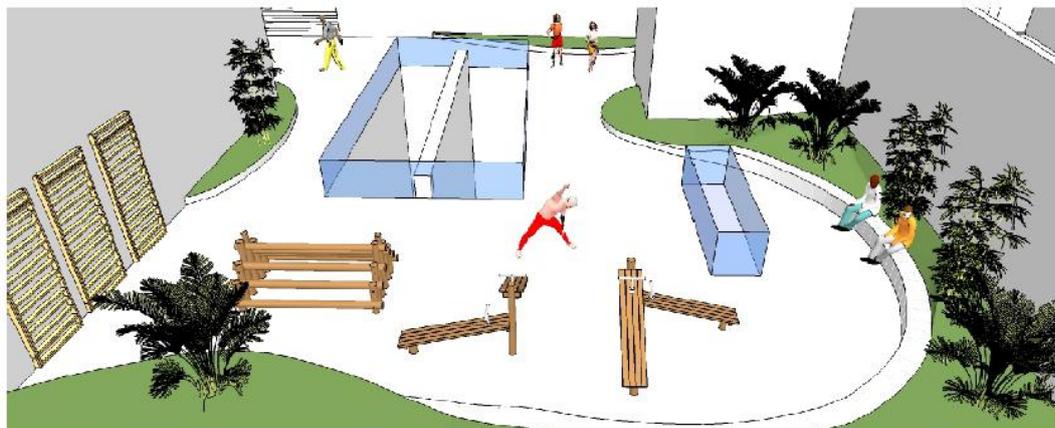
Imagen 3D de la zona gym, vinculada al centro de adolescentes, prevista en la cubierta de la manzana 303. Fuente: Elaboración propia.
